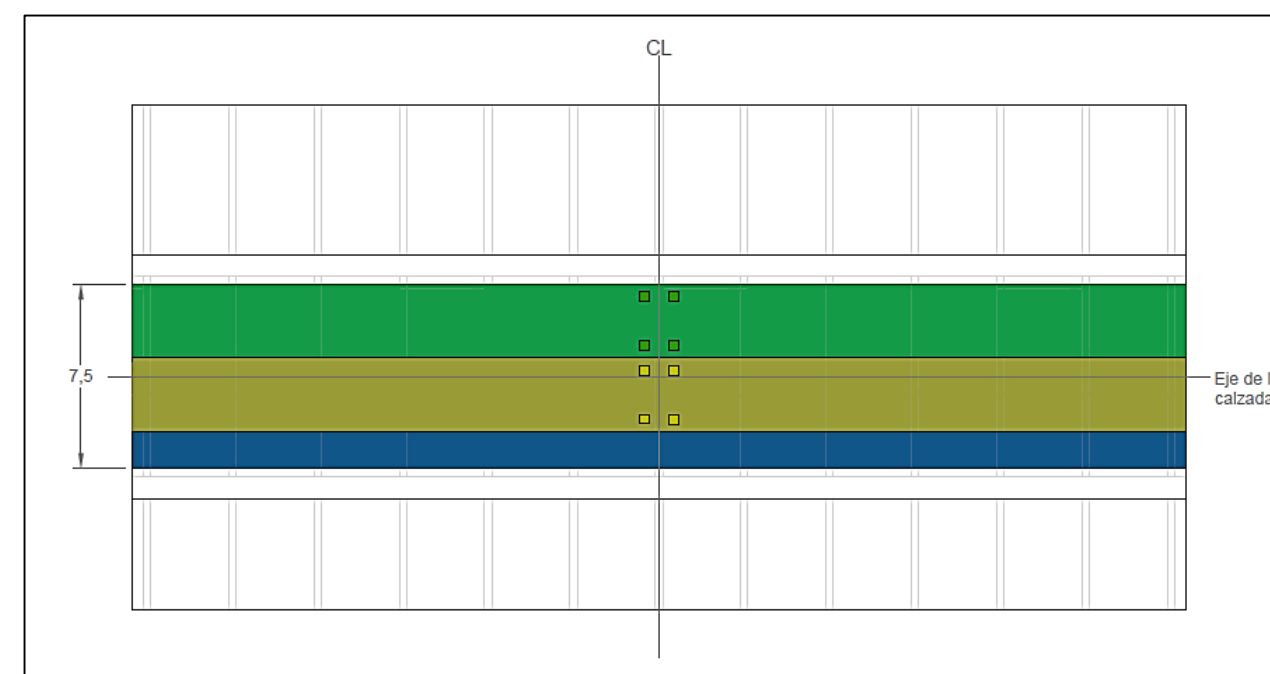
Caso 2 de sobrecargas de uso - Planta. Elaboración propia con AutoCAD
